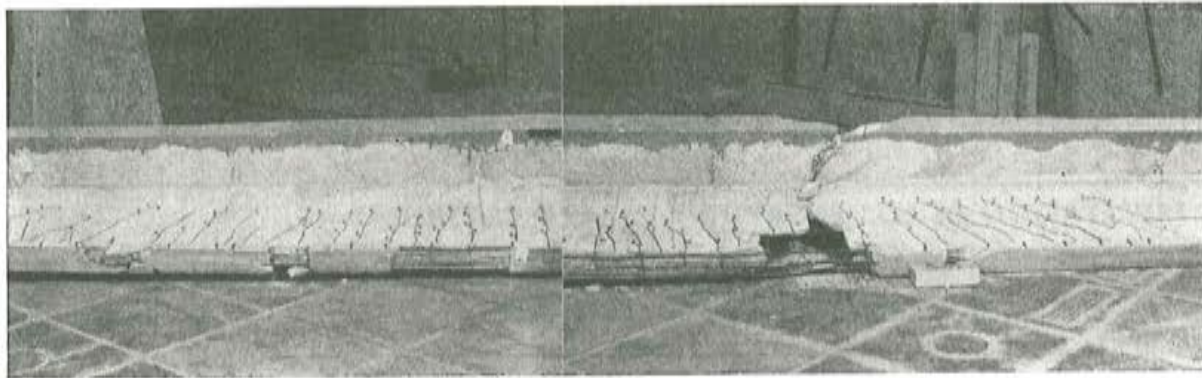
Fisuración y rotura viga testigo número 2.
